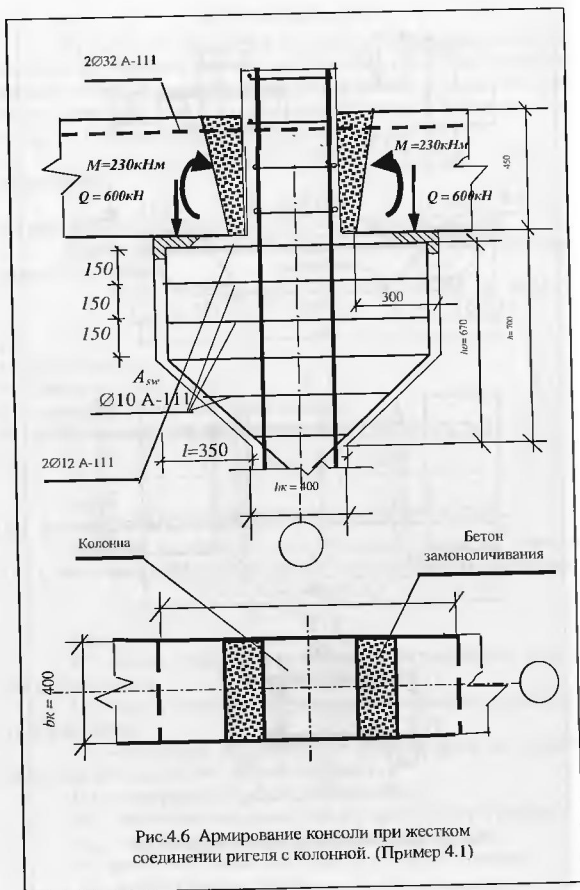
Армирование консоли при жестком соединении ригеля с колонной. (Пример 4.1)
